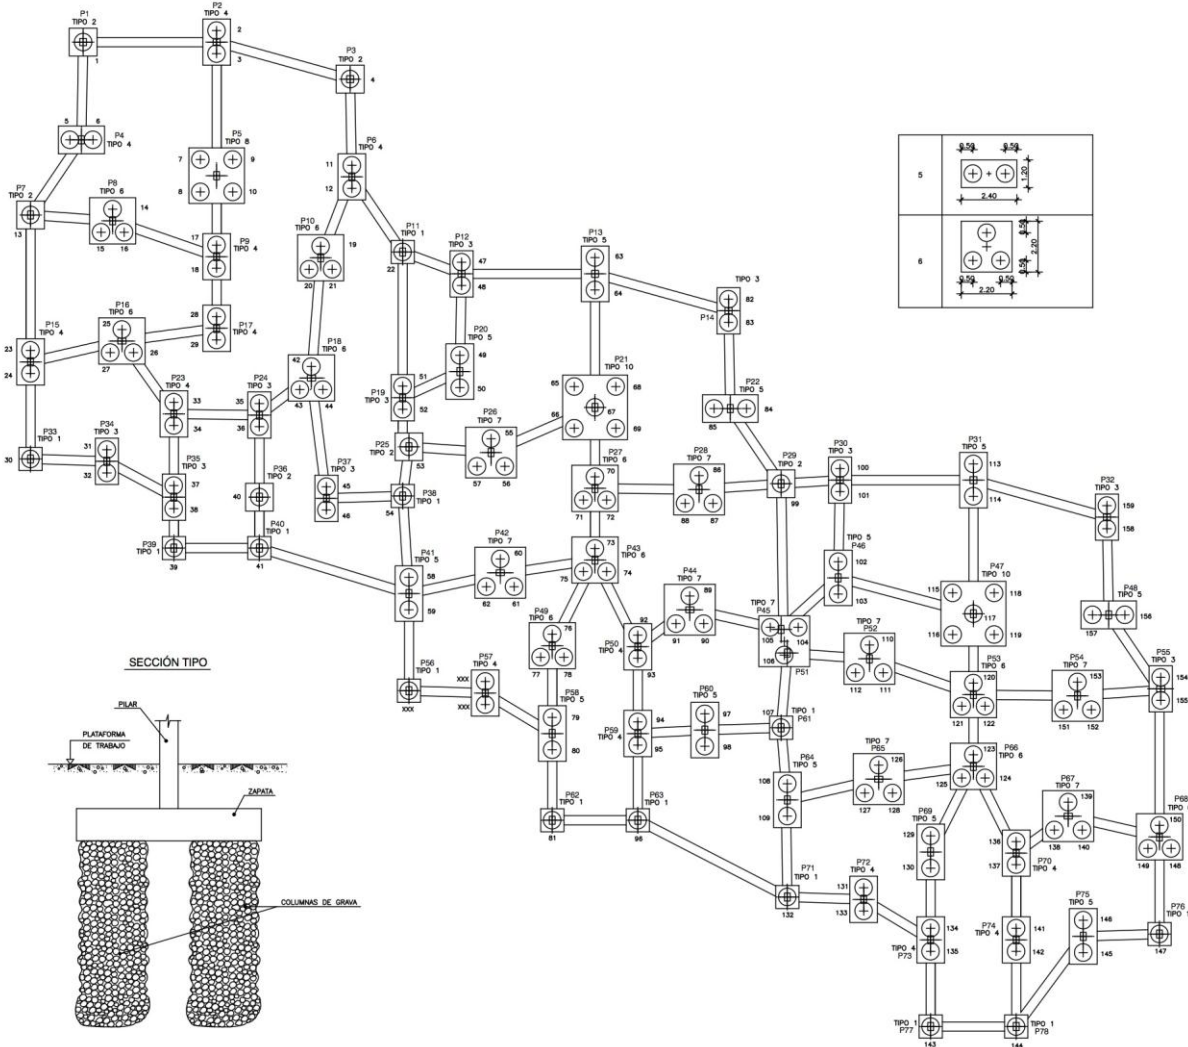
Planta fundaciones viviendas en Altos de Estepona (Malaga)
